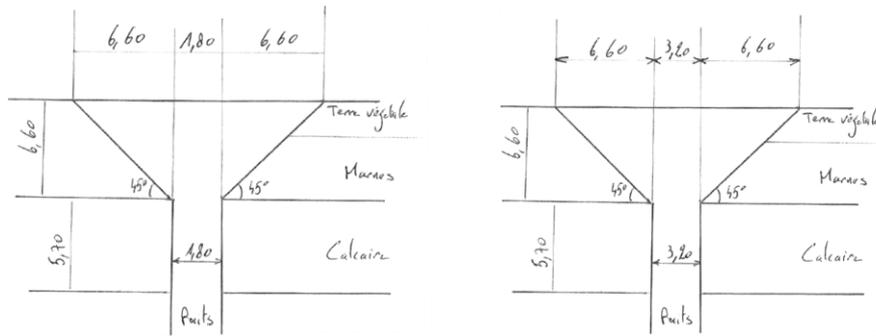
Extension transversale et longitudinale de l'effondrement de la tête de puits
